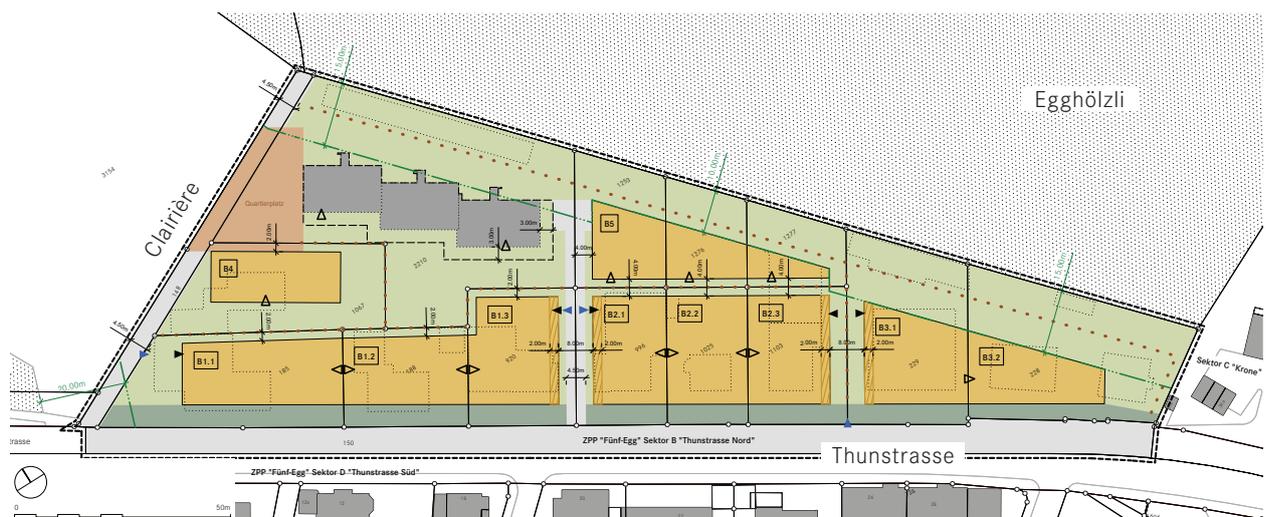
Auszug Teil-Überbauungsplan Thunstrasse Nord
